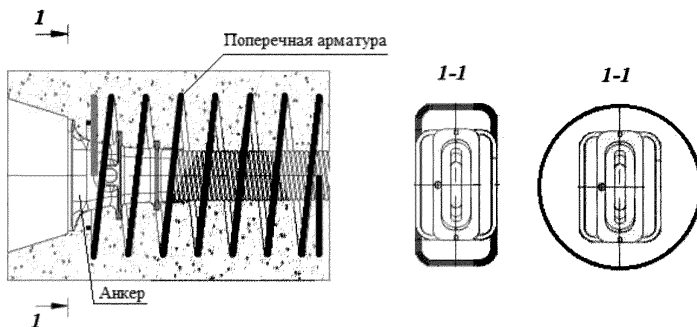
Конструкция анкера, совмещенного с поперечной арматурой
